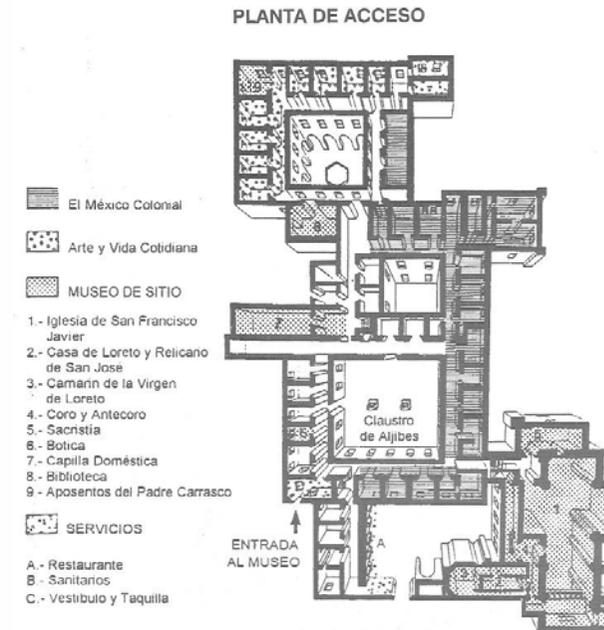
Planta de Acceso. Museo Nacional del Virreinato, Tepetzotlán, Edo. de México
